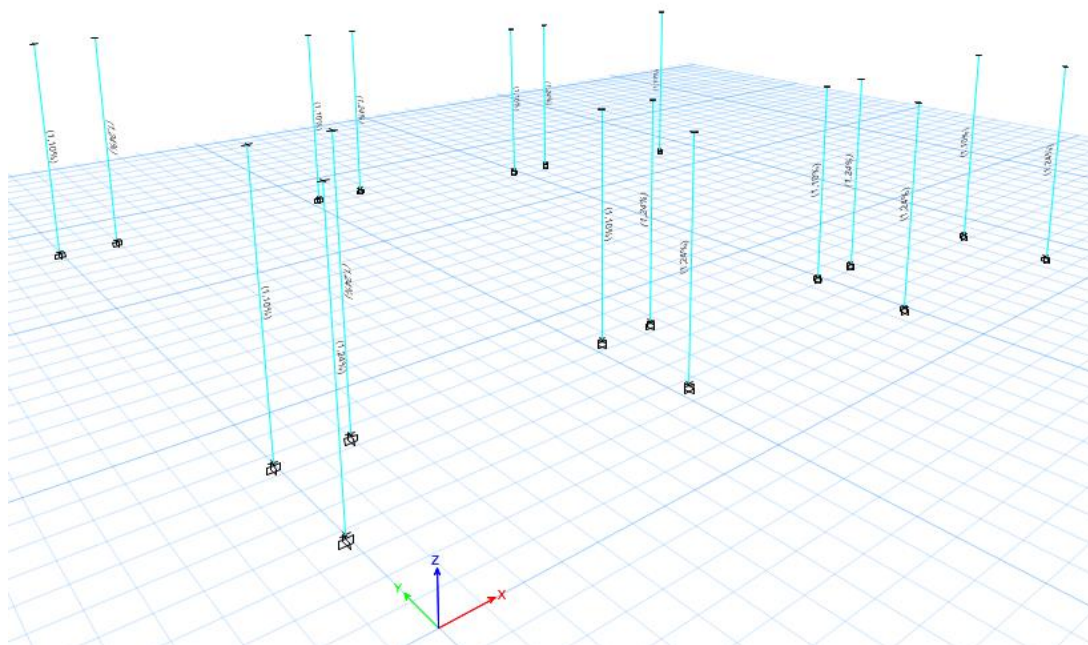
Refuerzo longitudinal columnas las aulas polivalentes en %
